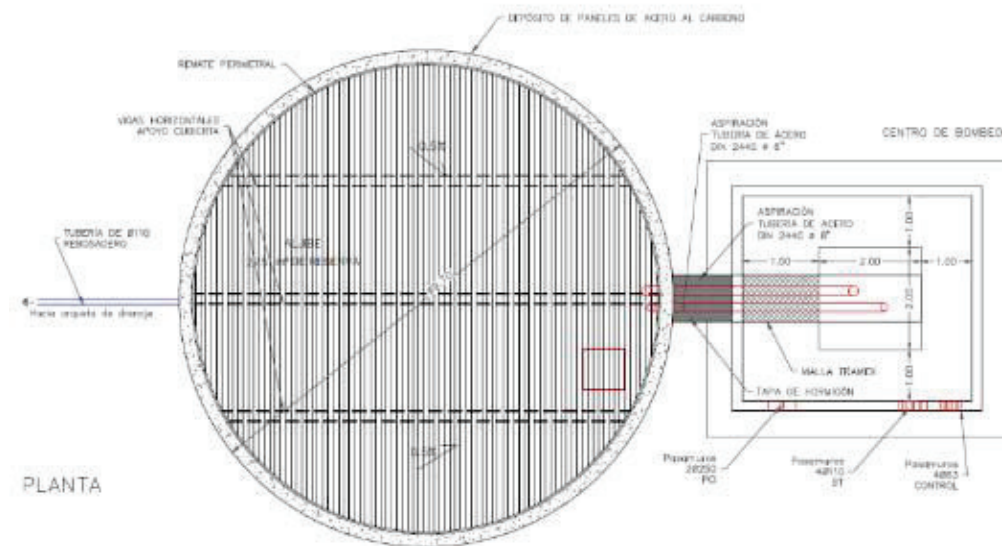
Planta del depósito de aguas – Extracto de los planos de Proyecto (Hoja N° 2)
